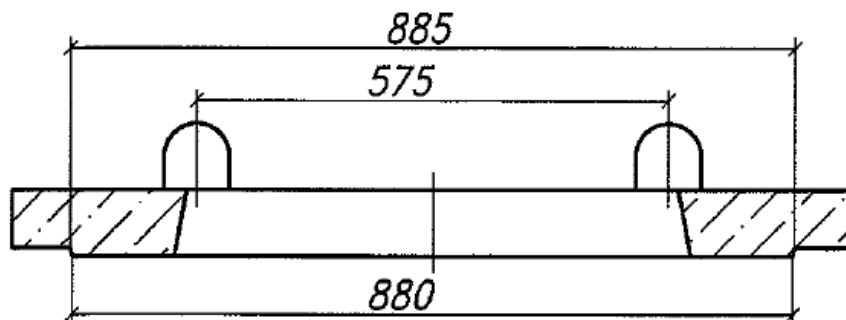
Размеры плиты перекрытия (вид с короткой стороны).
